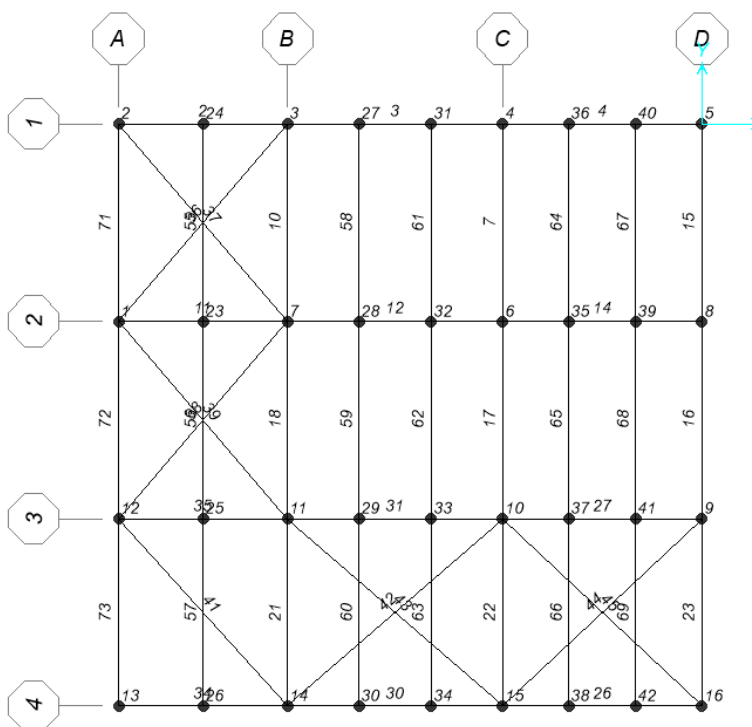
Vista in pianta modello struttura in elevazione – Piano 1 z = 5,5 - numerazione elementi frame e joint
